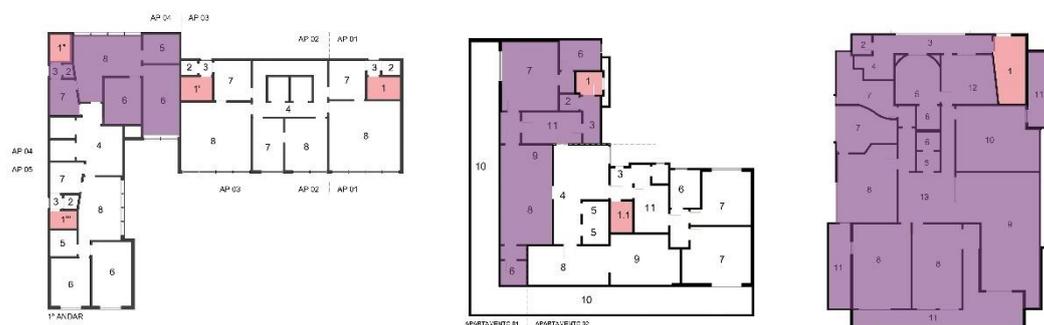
e 26: Exemplo de reprodução do pavimento tipo do Edifício Augusto Barretto. Todas as plantas foram feitas utilizando o software AutoCAD, levando em consideração as categorias de análise necessárias para a viabilização de respostas para a investigação proposta por esta pesquisa. Os quartos de empregada foram demarcados em vermelho. Fonte: Revista Acrópole nº 5 (1938, p. 37).
